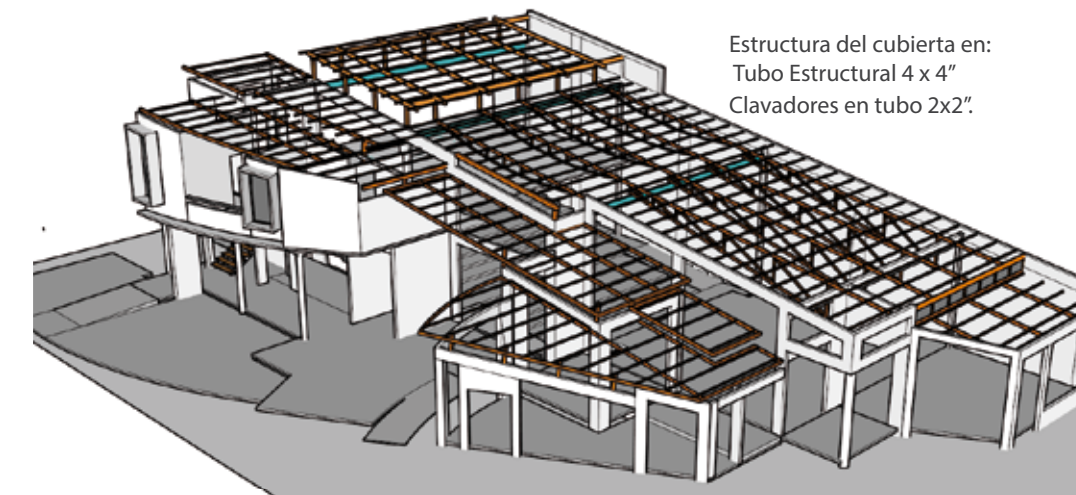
Propuesta estructural de cubierta 2° etapa.
